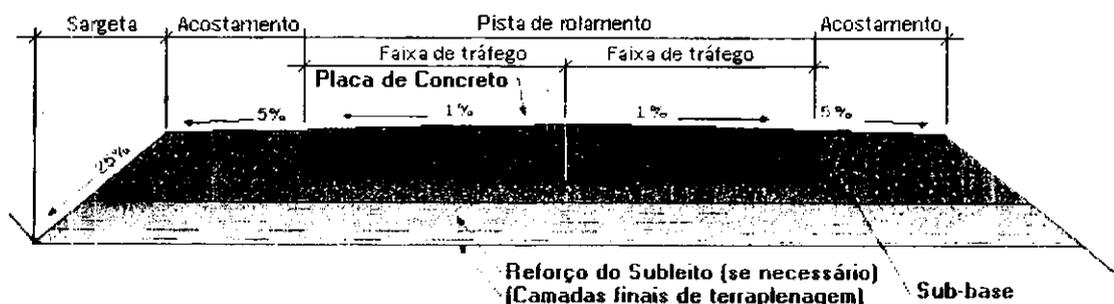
Seção Transversal Típica de Pavimento Rígido
